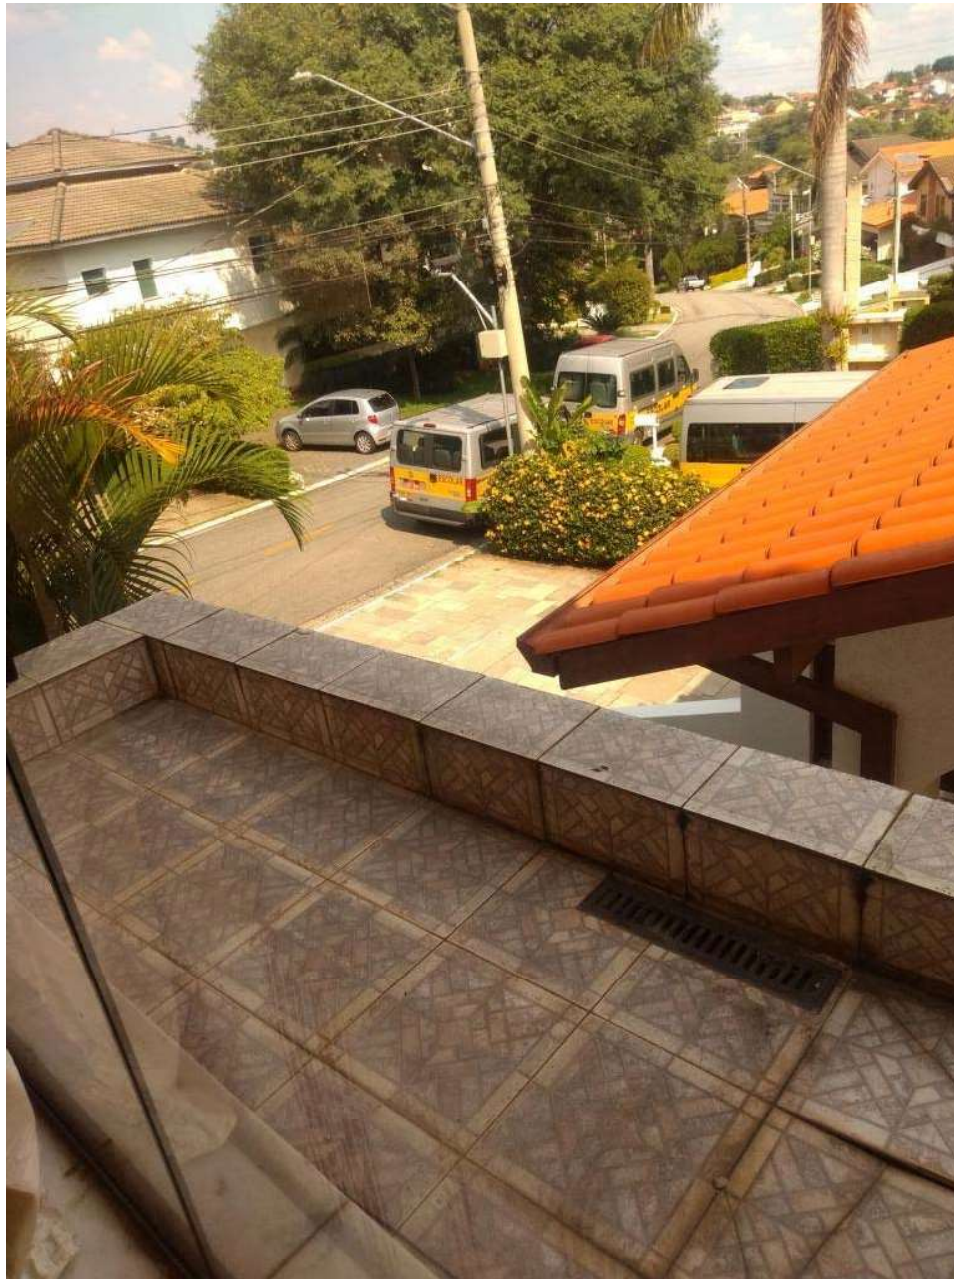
SACADA DESCOBERTA DA SUÍTE 2.
